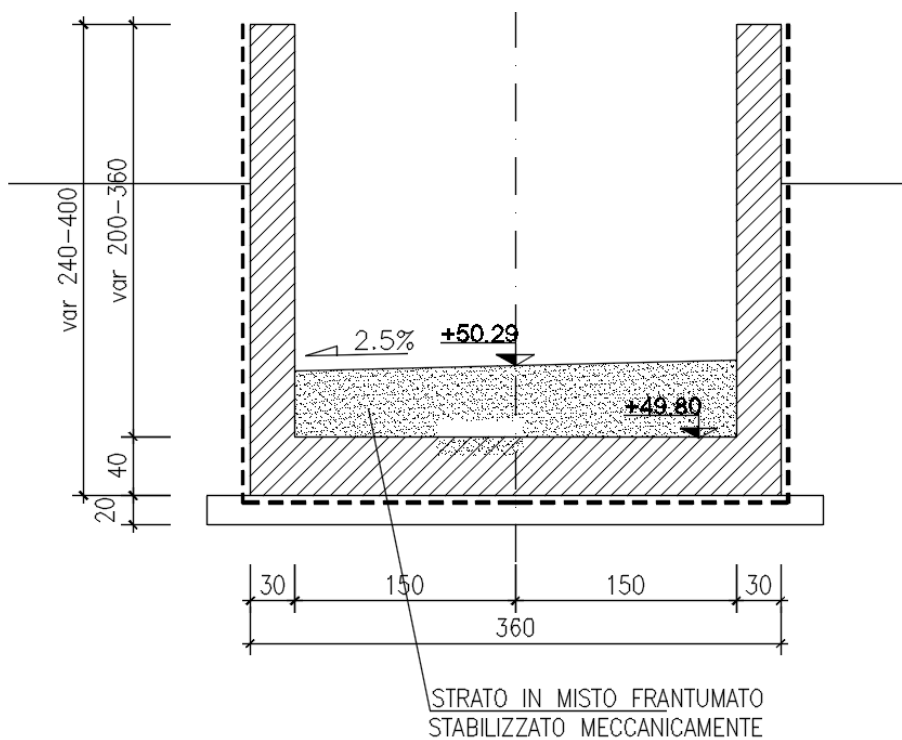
Prospetto longitudinale del muro ad U tipo 3 di imbocco del sottovia IN04
